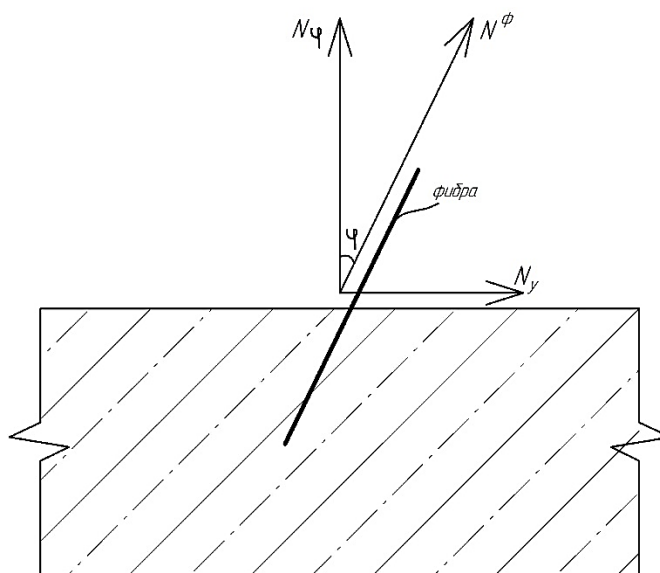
Схема работы фибр, ориентированных под углом к внешней нагрузке
